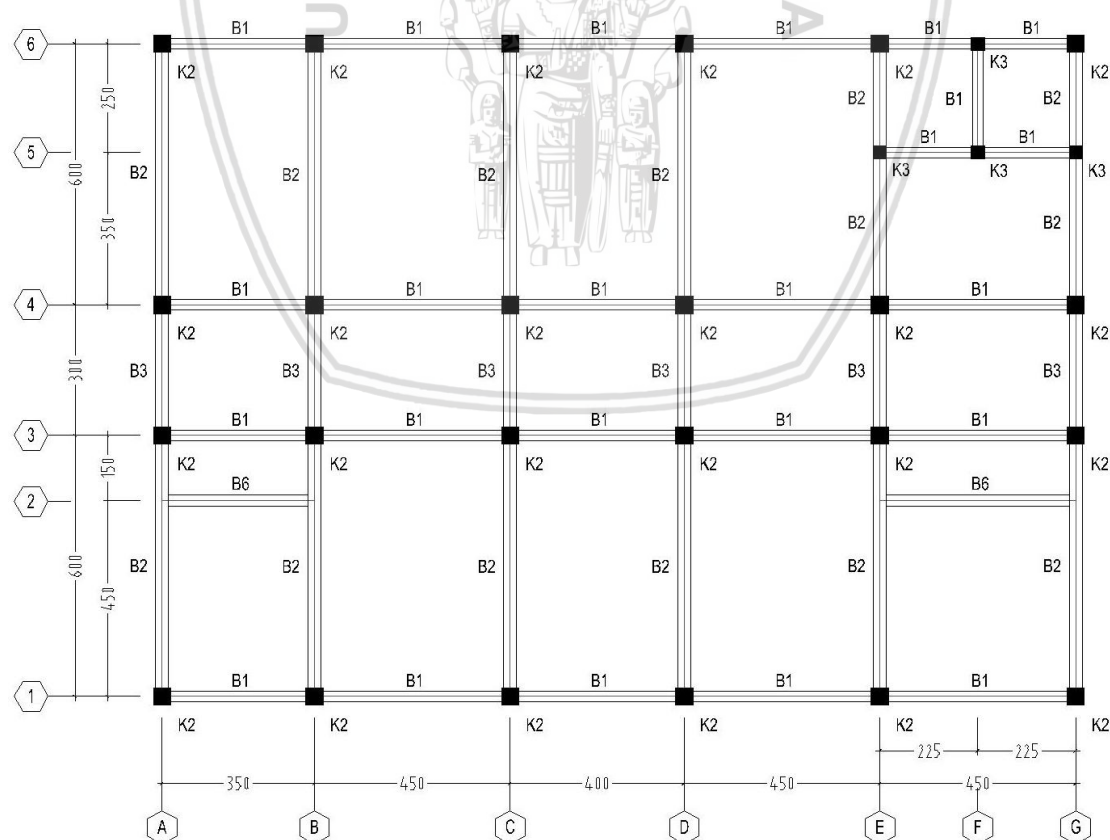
Pemodelan Denah Balok-Kolom Lantai Dasar (Level 0)
